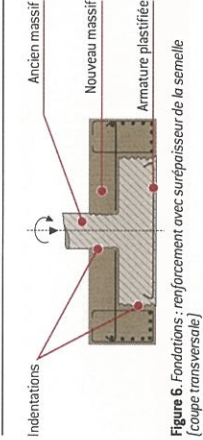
Fondations : renforcement avec surépaisseur de la semelle (coupe transversale)
